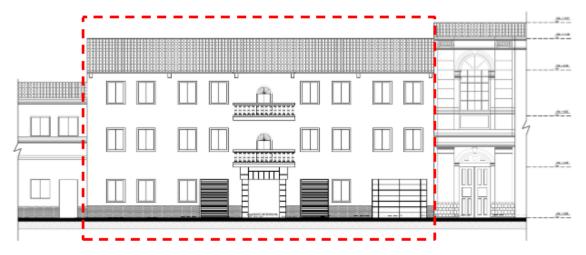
Fachada Urbana sobre la calle Vicente León, sentido Sur - Norte Fuente: Memoria Histórica, 2021.
